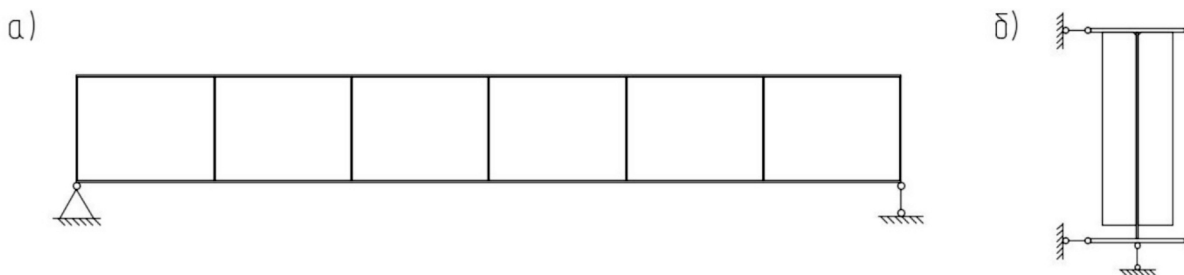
а) Расчетная схема балки; б) Характерное сечение балки
